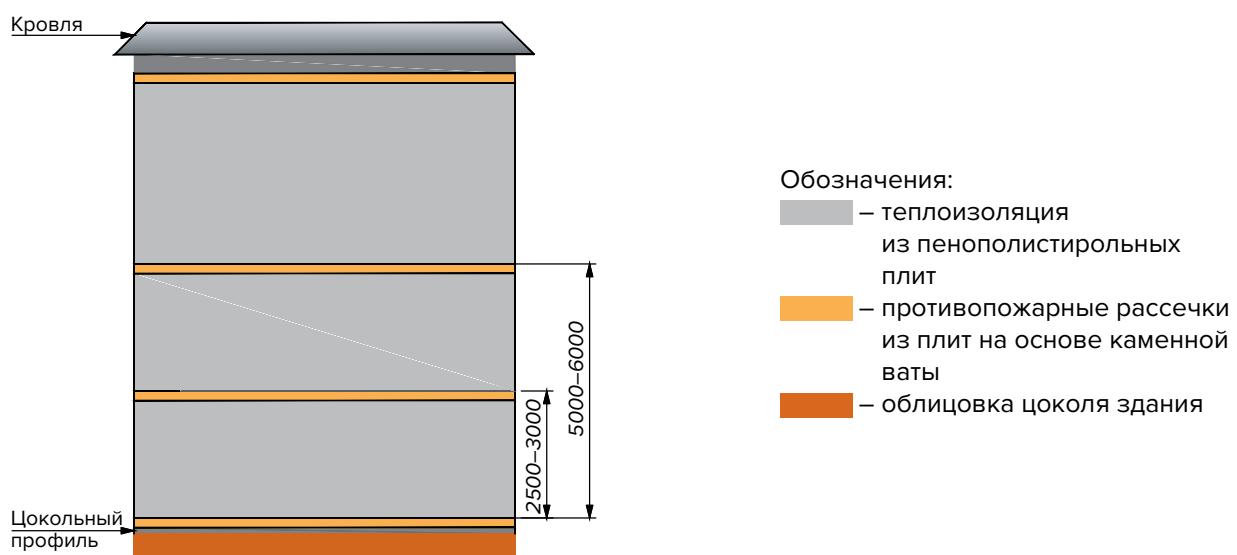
Размещение теплоизоляционных плит на глухих стенах здания
